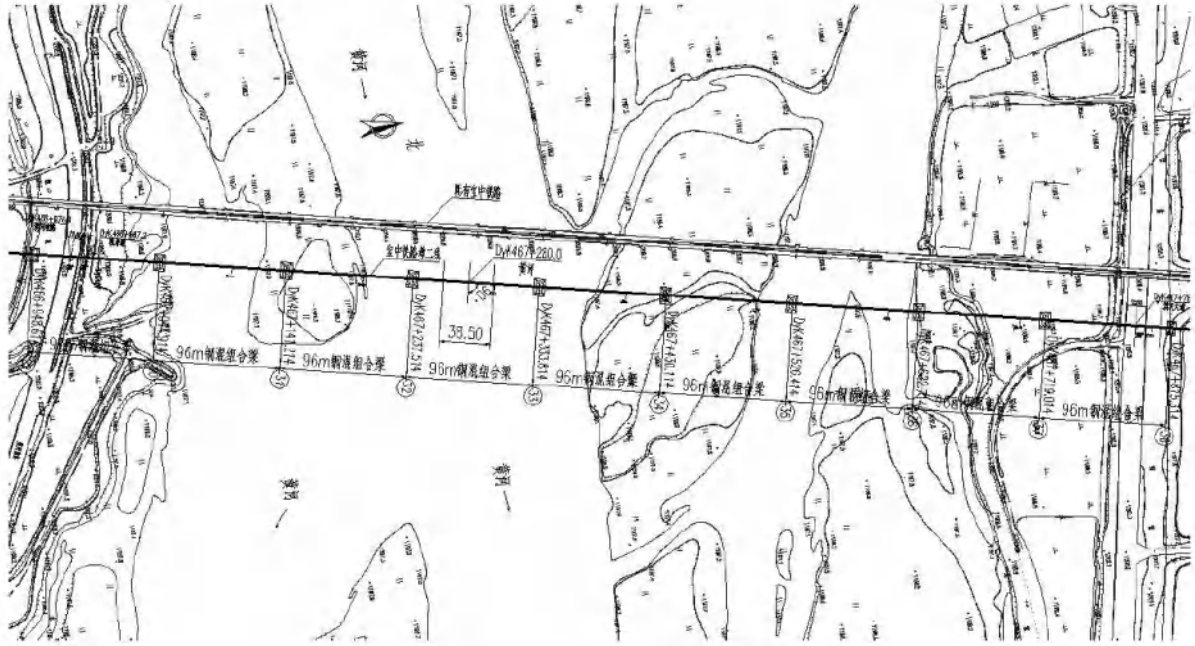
宝中铁路二线黄河特大桥(跨越黄河处)平面图
